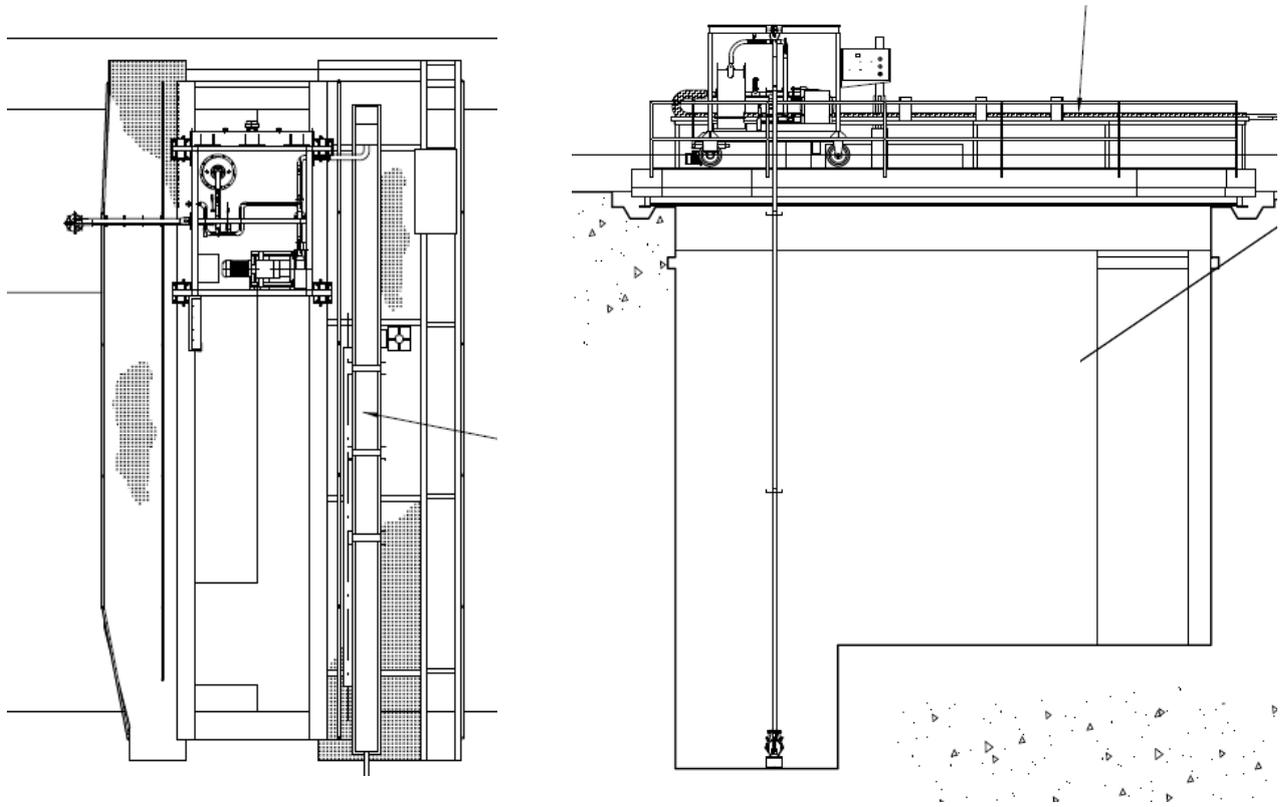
Posizionamento dello Skid mobile sulla Gru Cesti: pianta e prospetto.
